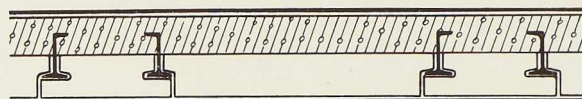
Dalle en béton coulée sur plaques de plâtre.
